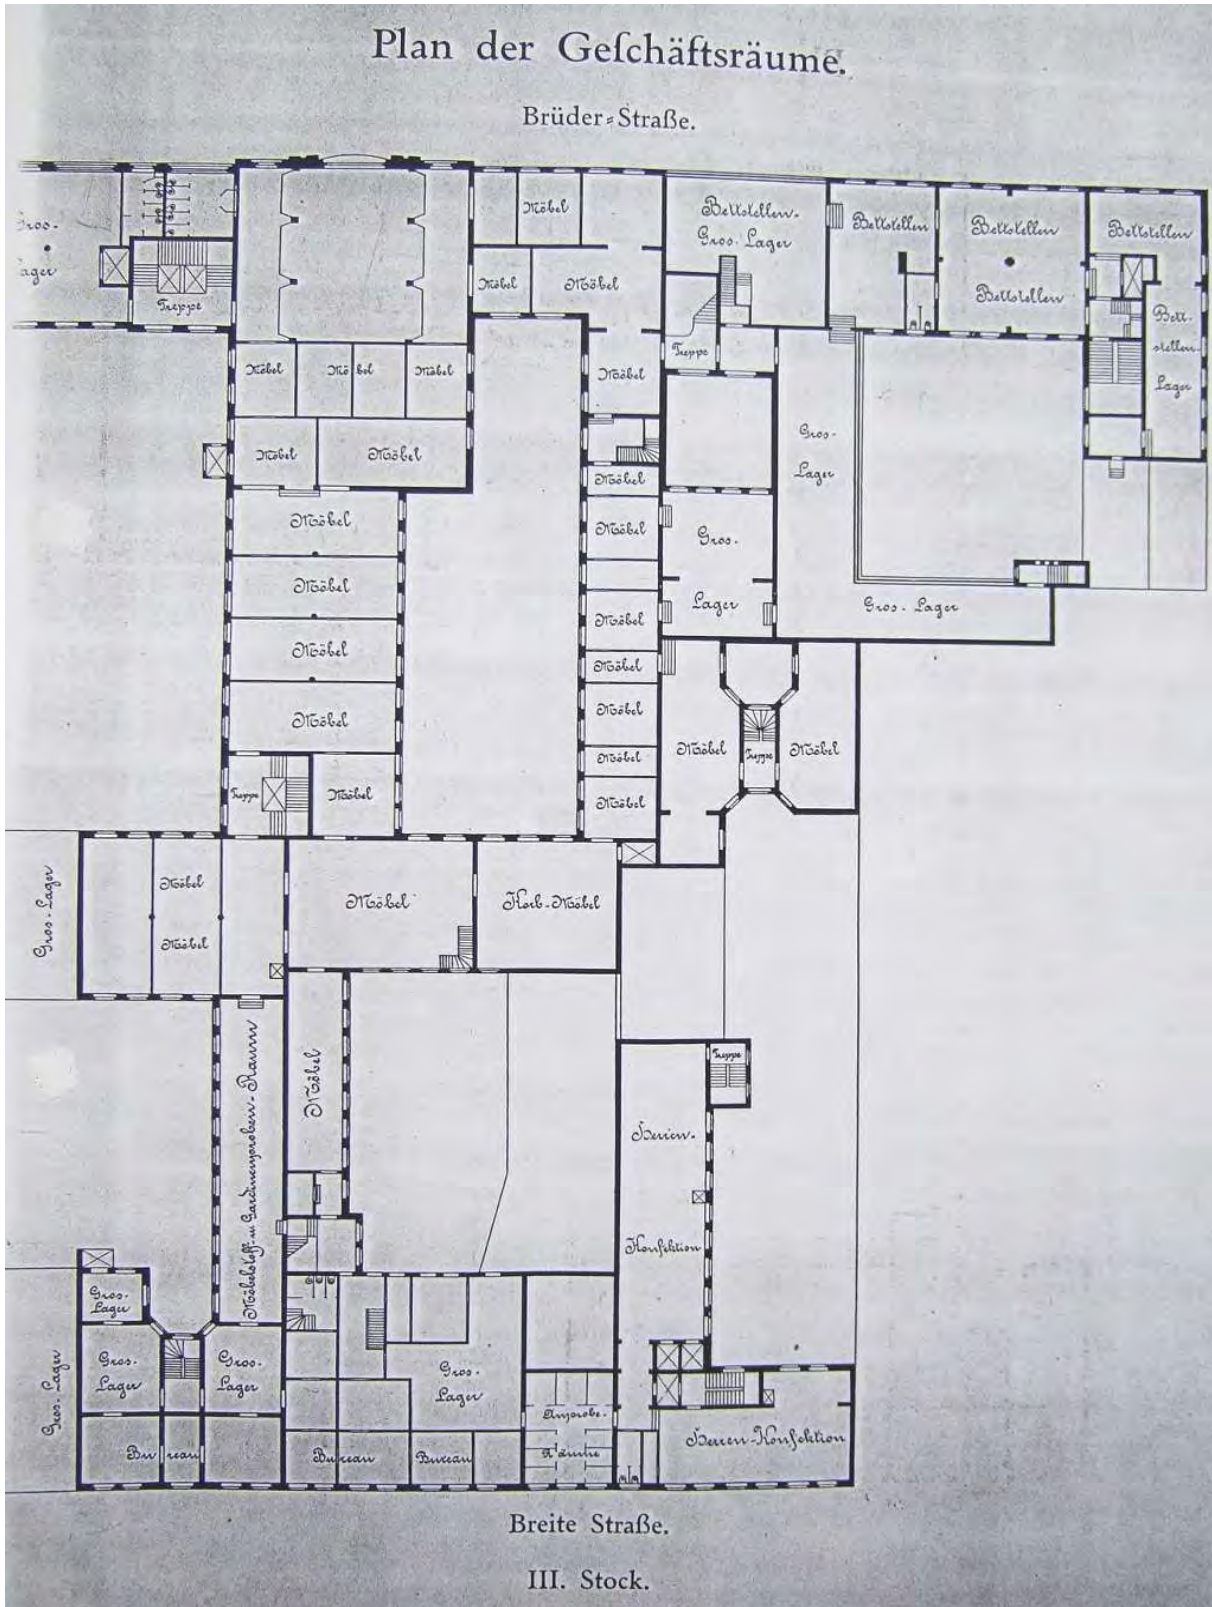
Grundriss des dritten Stockwerks bei Rudolph Hertzog.
